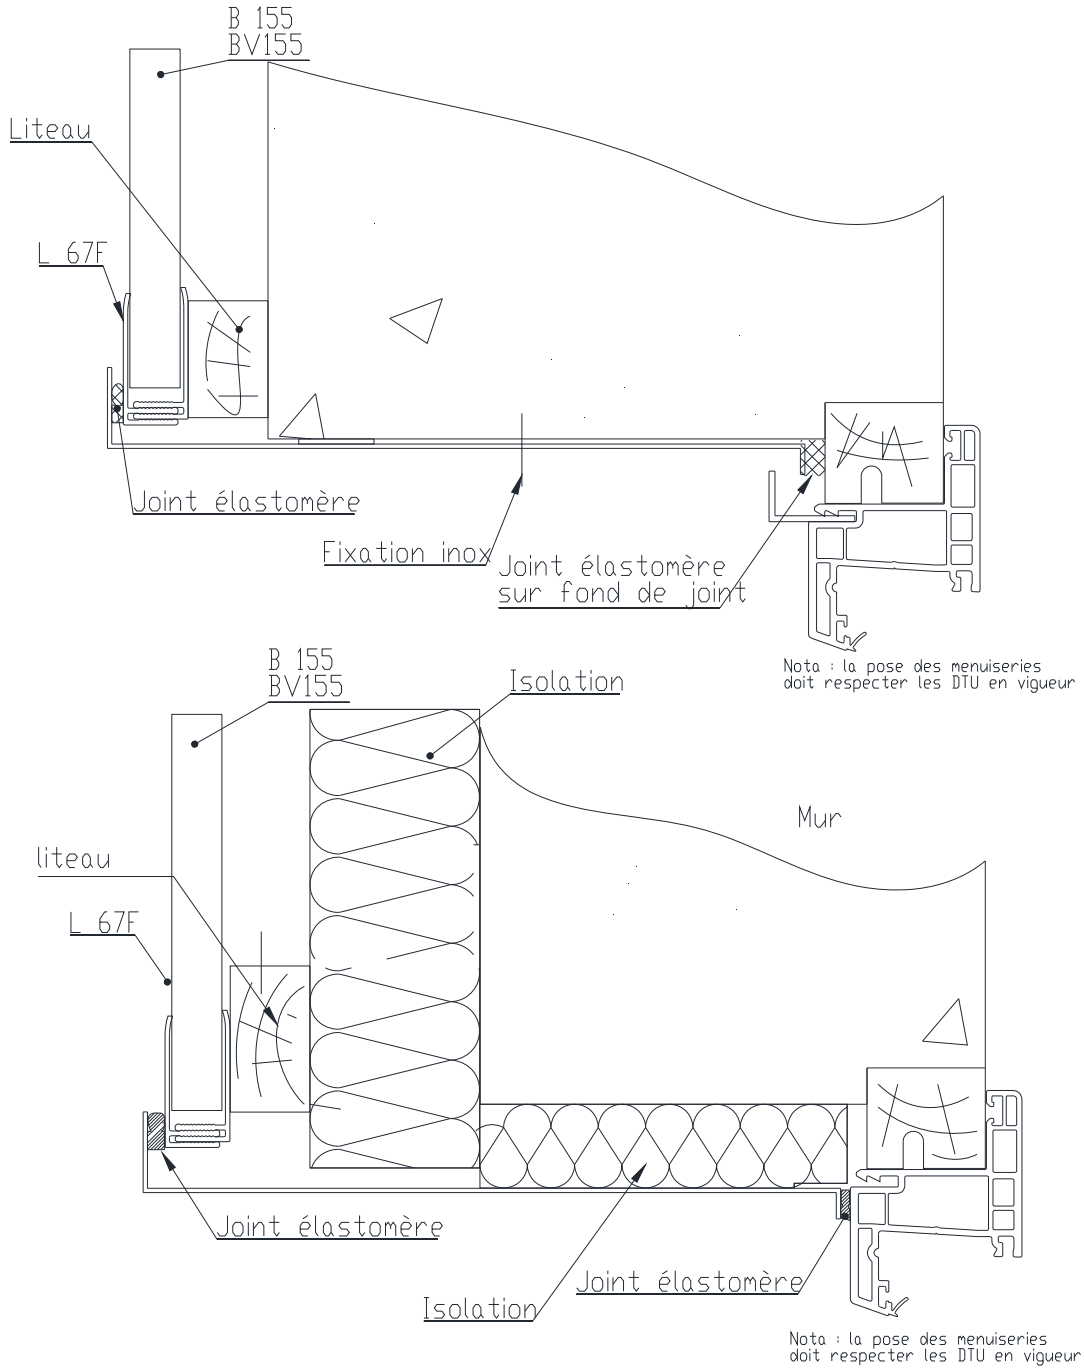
Tableau et appui de baie avec isolation - coupe verticale
